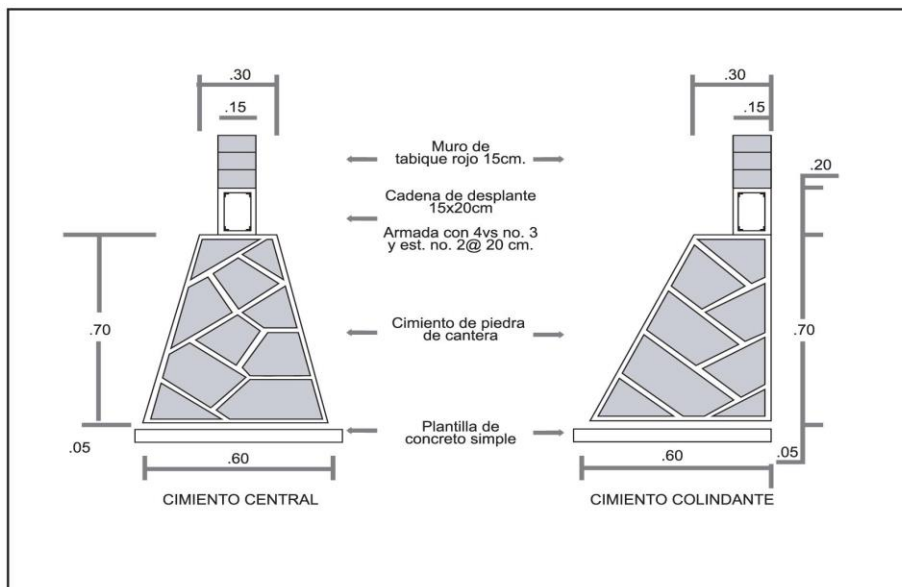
Mampostería. Fuente: (ANTAAC, 2016).
